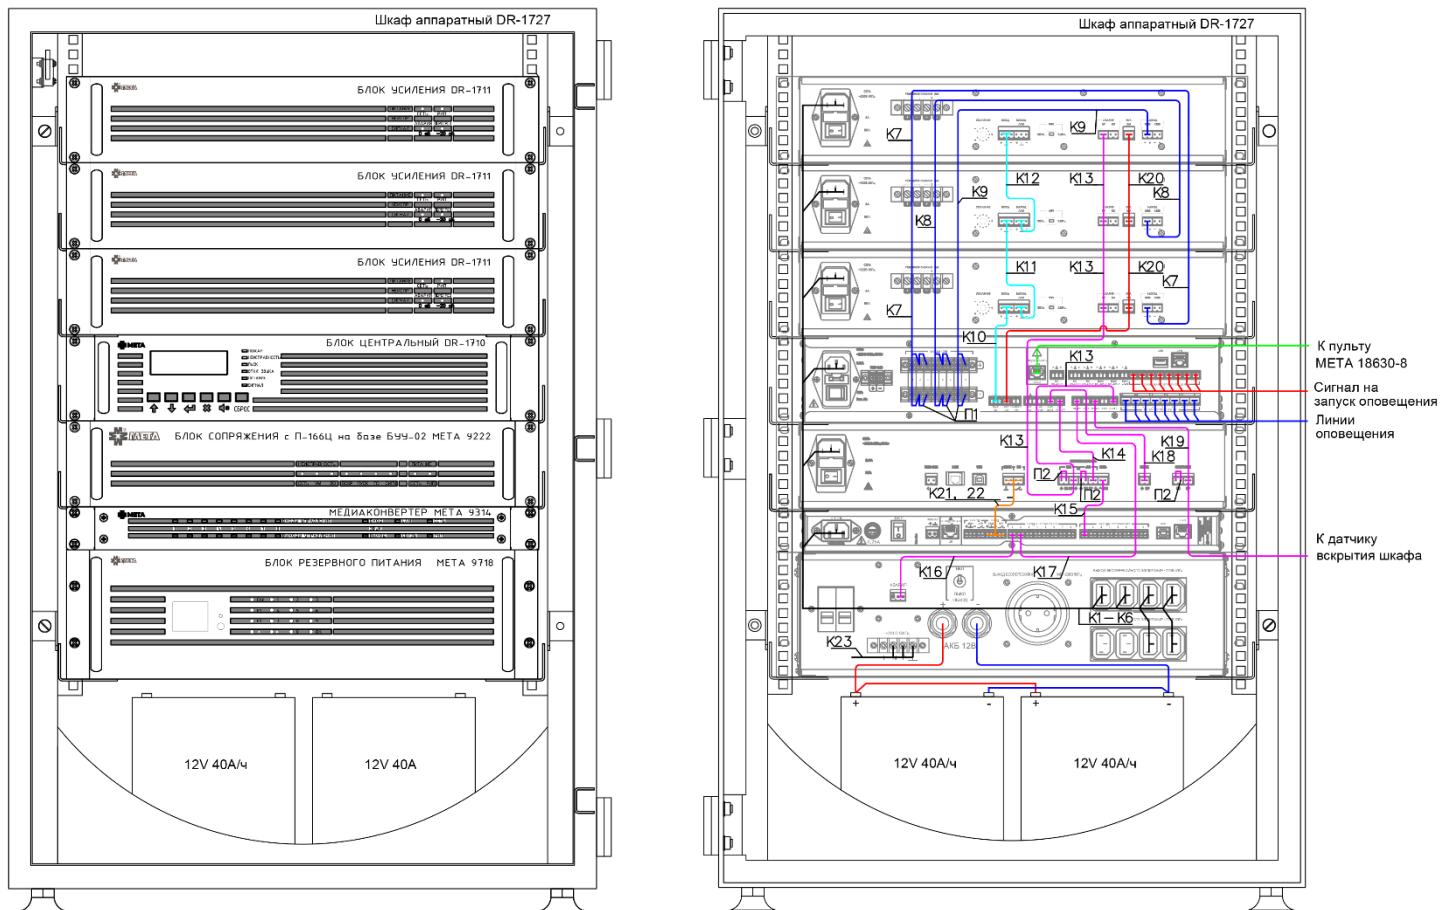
Внешний вид УКК МЕТА 8801-06.
